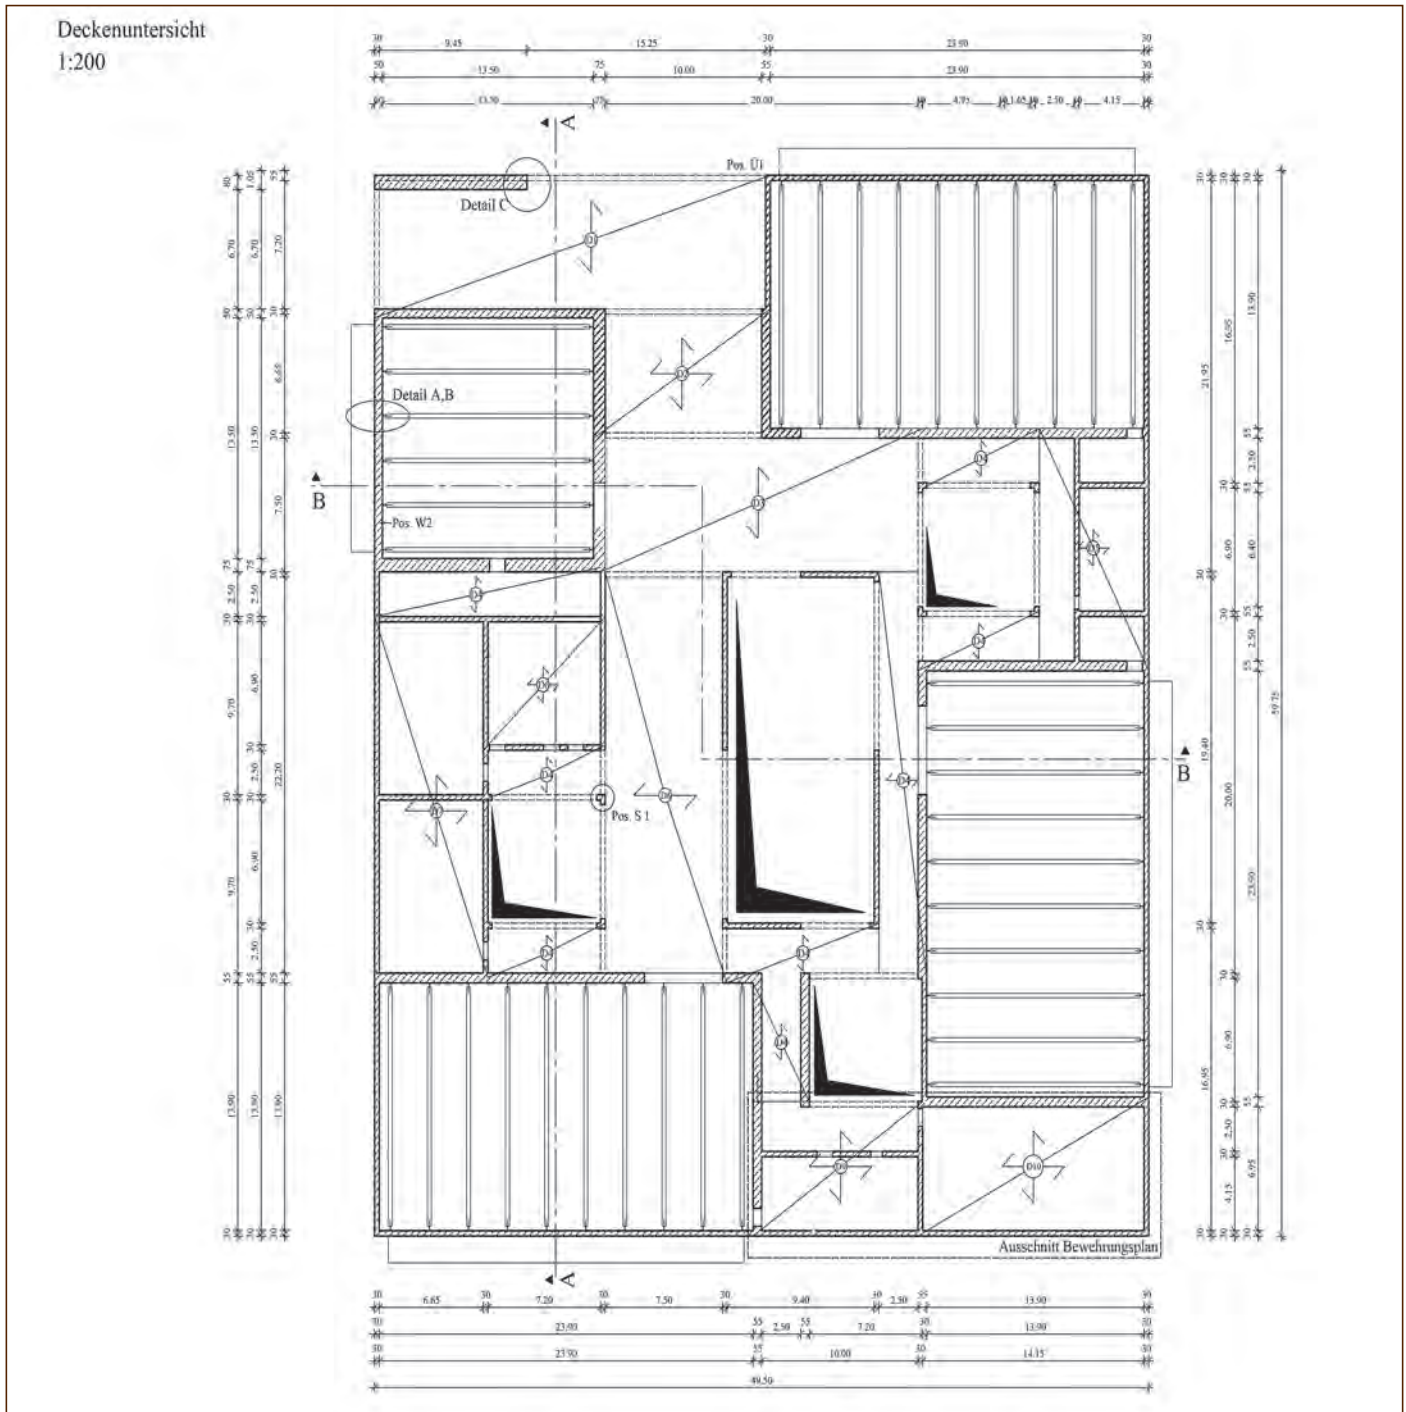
Deckenuntersicht, Projekt 2 – Sporthalle WS 2014/15, Verfasser: Arne Wittenborn (Bachelor Architektur) und Michael Adelung (Bachelor Bauingenieurwesen), betreut an den Lehrstühlen Baukonstruktion und Stahlbau
